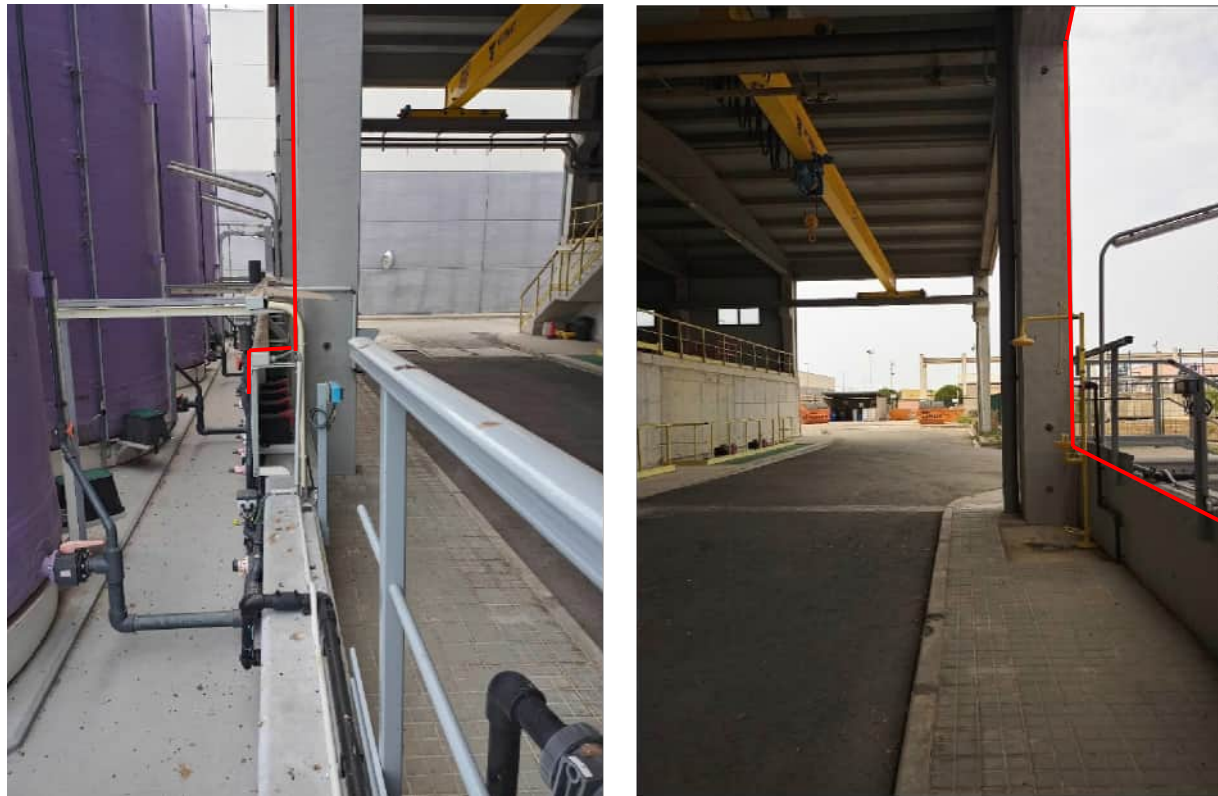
Exterior de la nau, façanes Nord (a l'esquerra) i Oest (primer pla), amb el detall sota paviment de les conduccions existents i la fonamentació projectada
